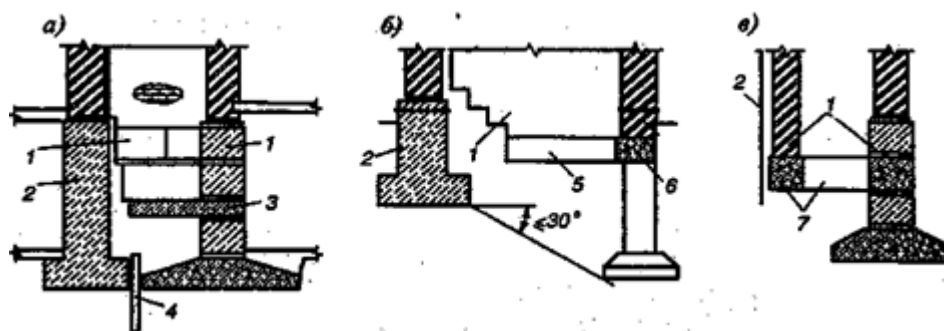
Примыкание фундаментов пристроек к существующим: а - с заложением подошвы на уровне существующего фундамента; б - то же, с заглублением; в - то же, но фундамент отодвинут от старого, стены примыкания опираются на консольную конструкцию; 1 - новые фундаменты; 2 - то же, старый; 3 - консольная железобетонная плита; 4 - шпунтовый ряд; 5 -
